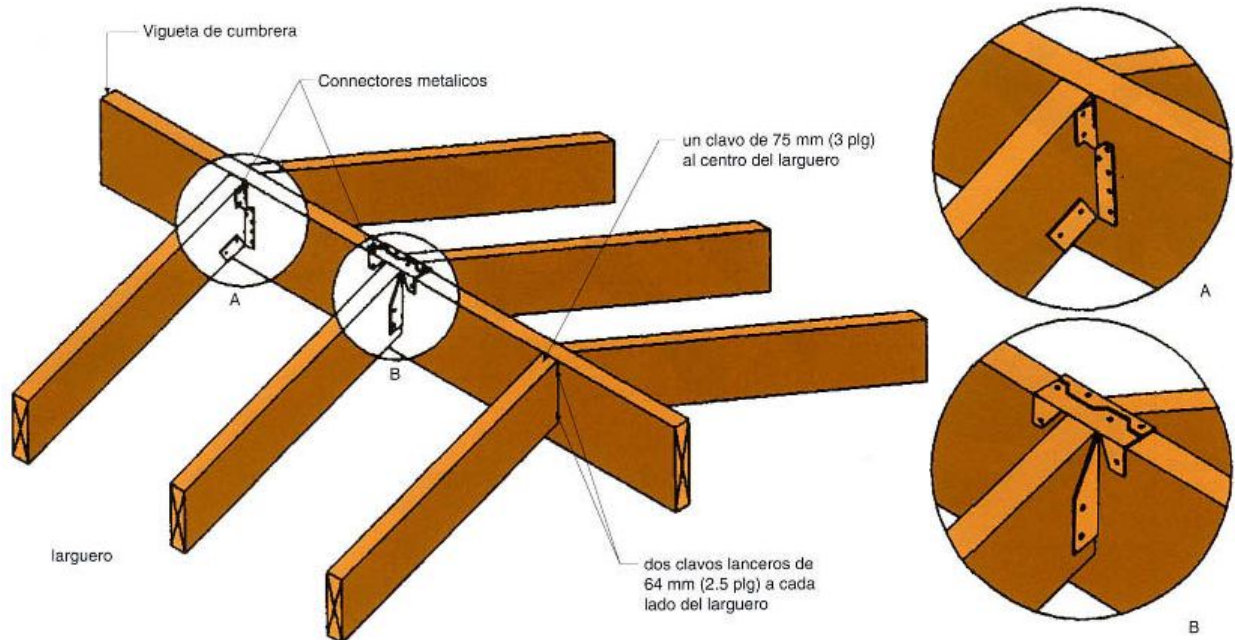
Fijación de Viguetas a Viga de Cumbrera.
